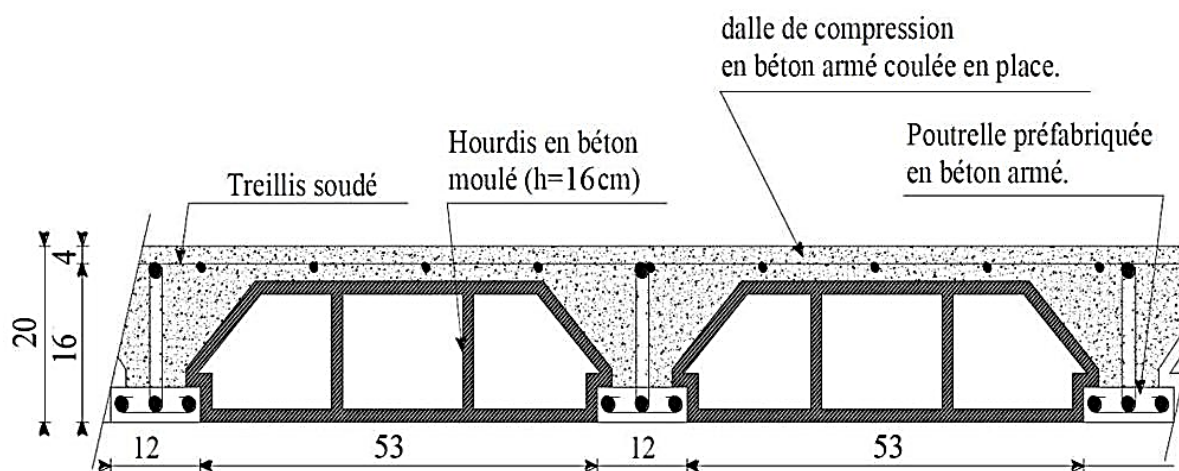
Coupe d'un plancher en corps creux (16+4)
